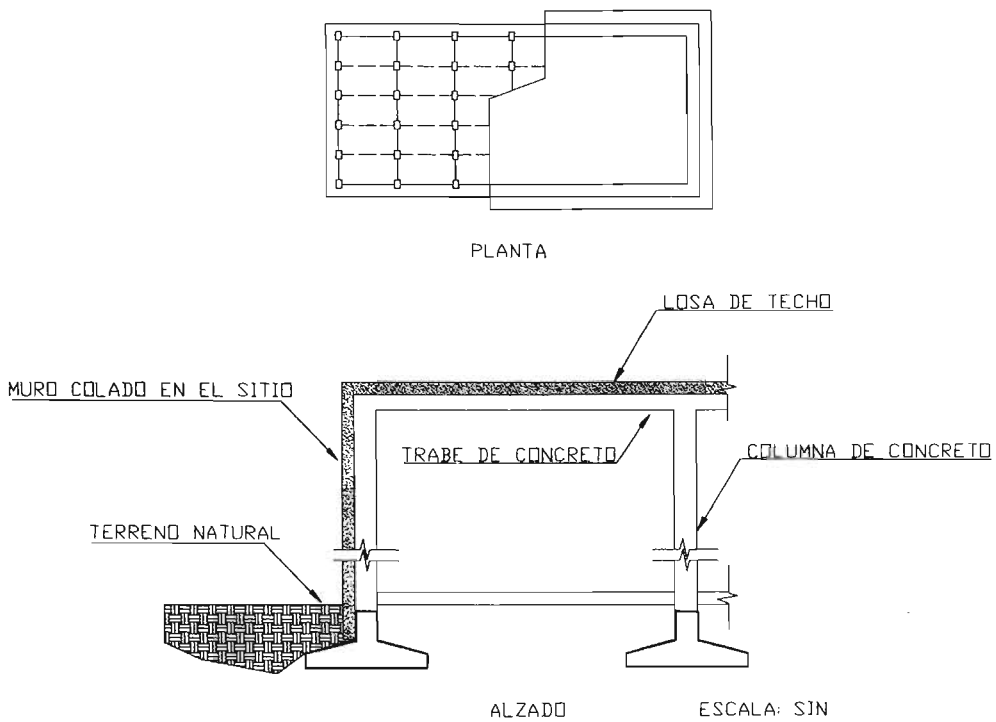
Estructura de muros de concreto colados en el sitio.
